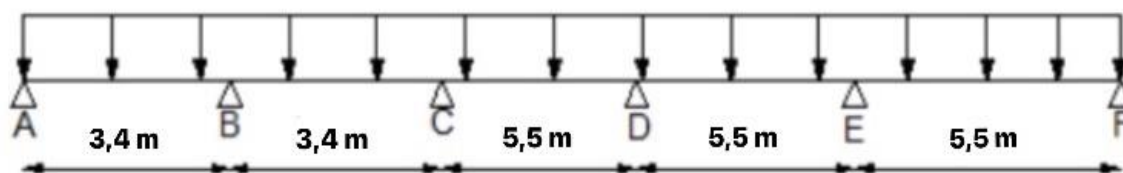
Schéma statique de la poutre reposant sur six appuis.
